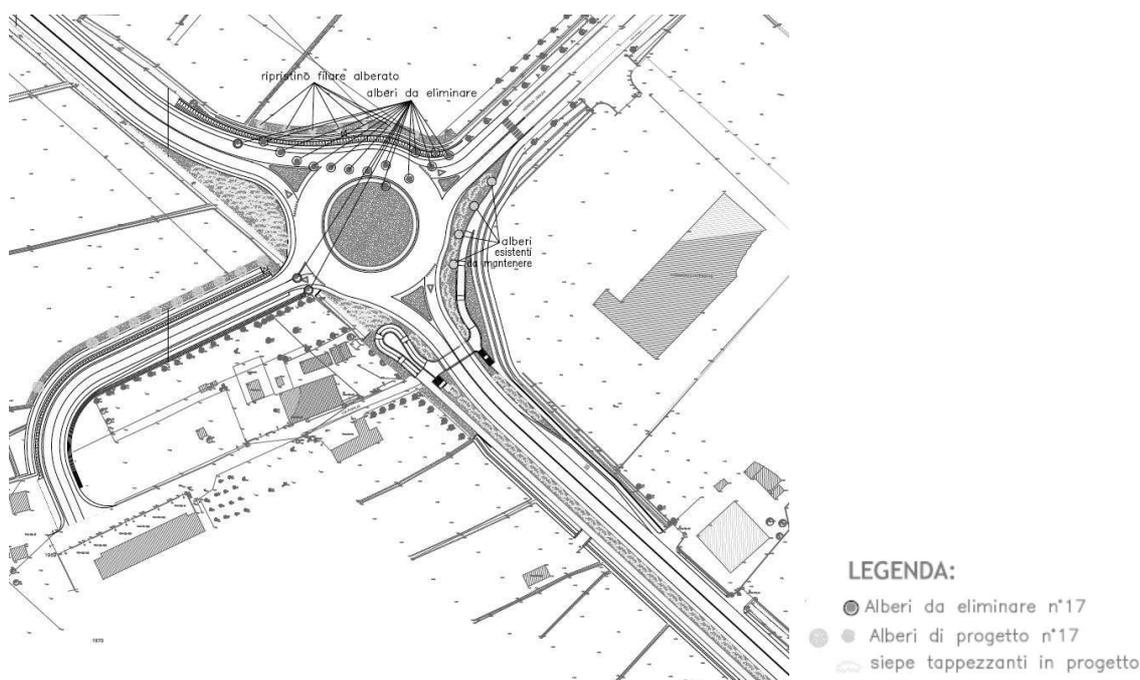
Planimetria opere a verde (Fonte: Allegati alla Lista di controllo)
